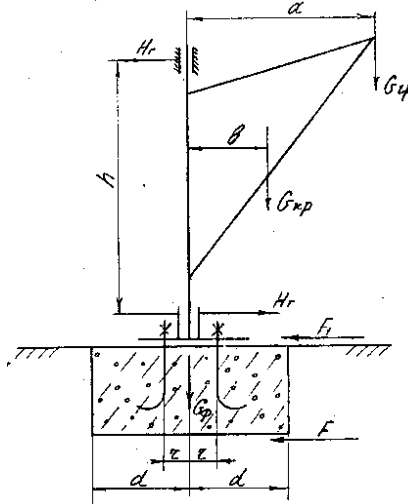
Схема для розрахунку фундаменту одноопорного крана
